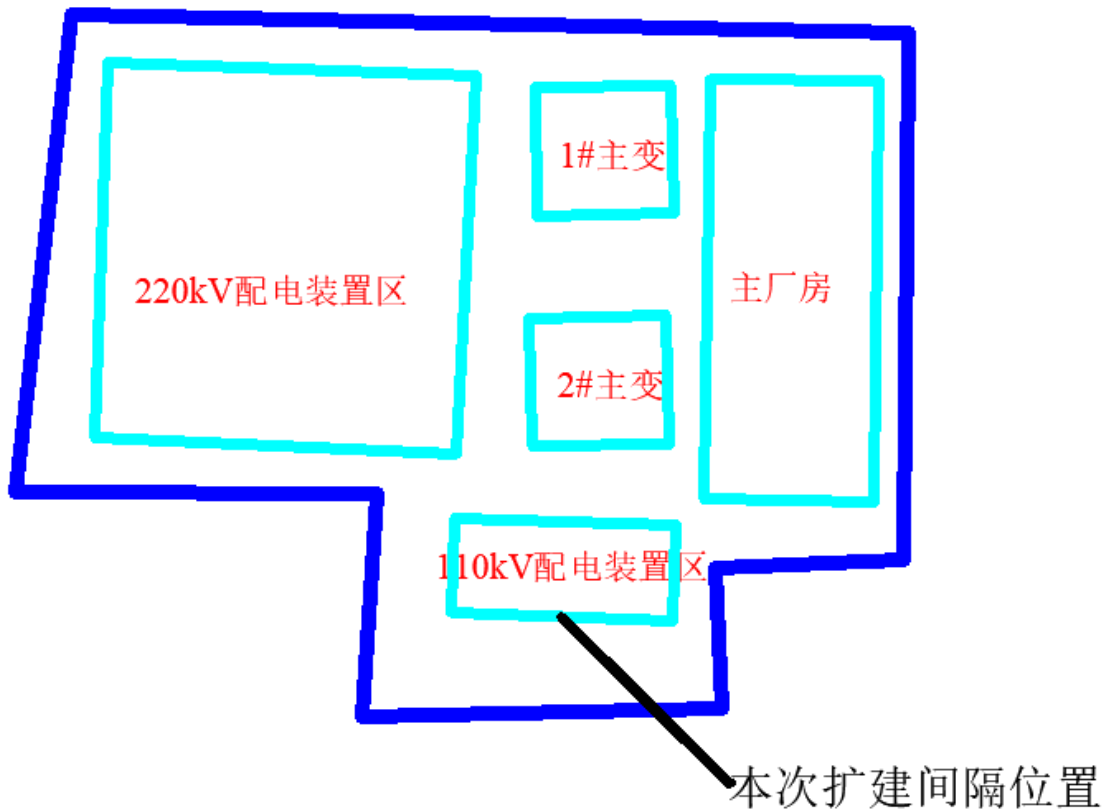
红叶二级水电站 220kV 升压站平面布置图
